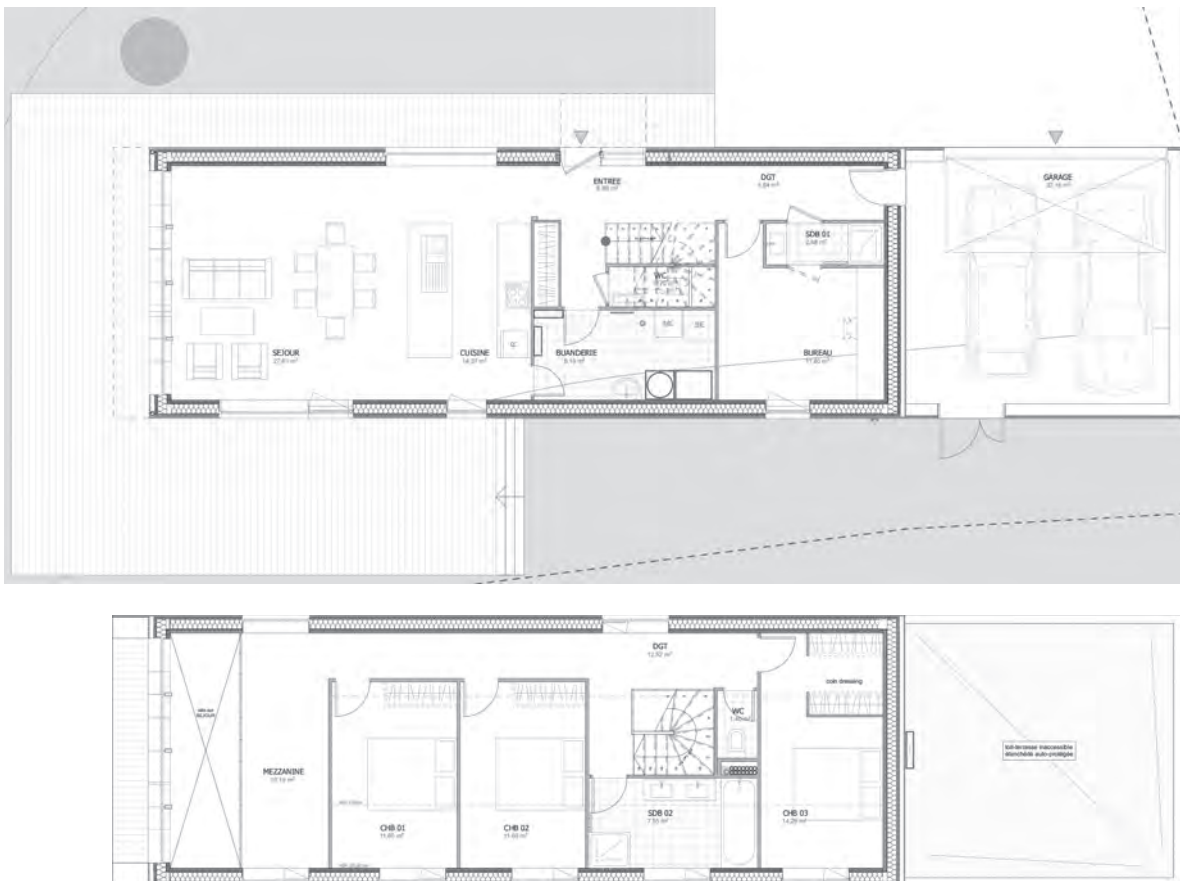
Plan du rez-de-chaussée avec séjour, cuisine et une chambre-bureau et du R+1 avec la grande mezzanine qui donne sur le séjour, les trois chambres et la salle de bains Source : Quinze Architecture
